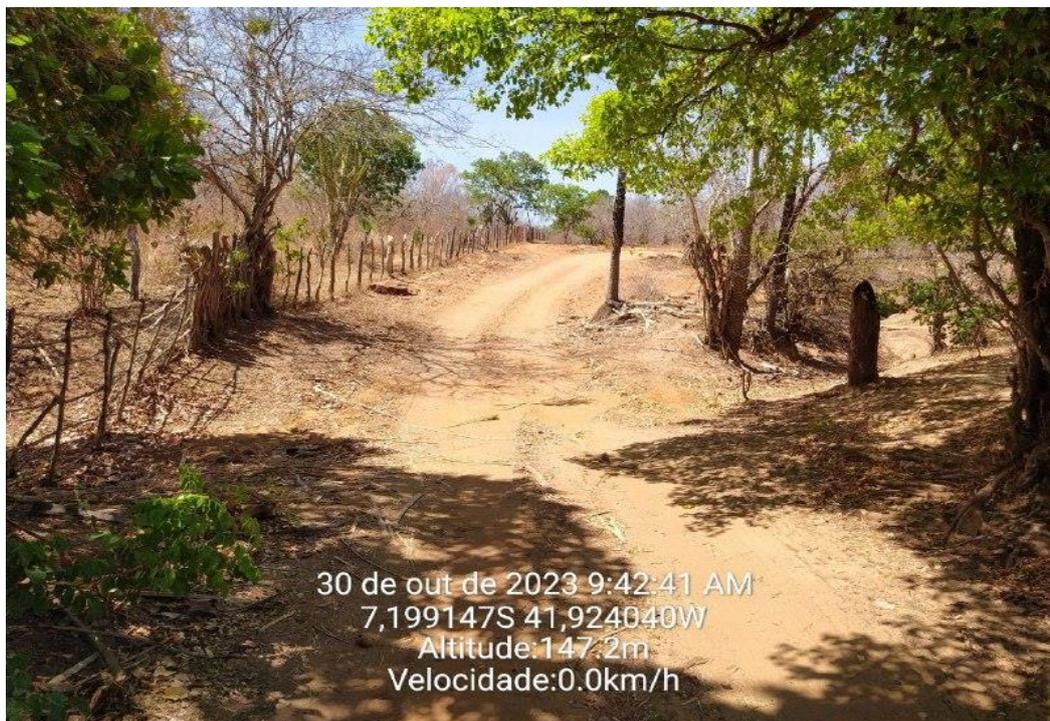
PASSAGEM MOLHADA 03 - TRECHO 02
